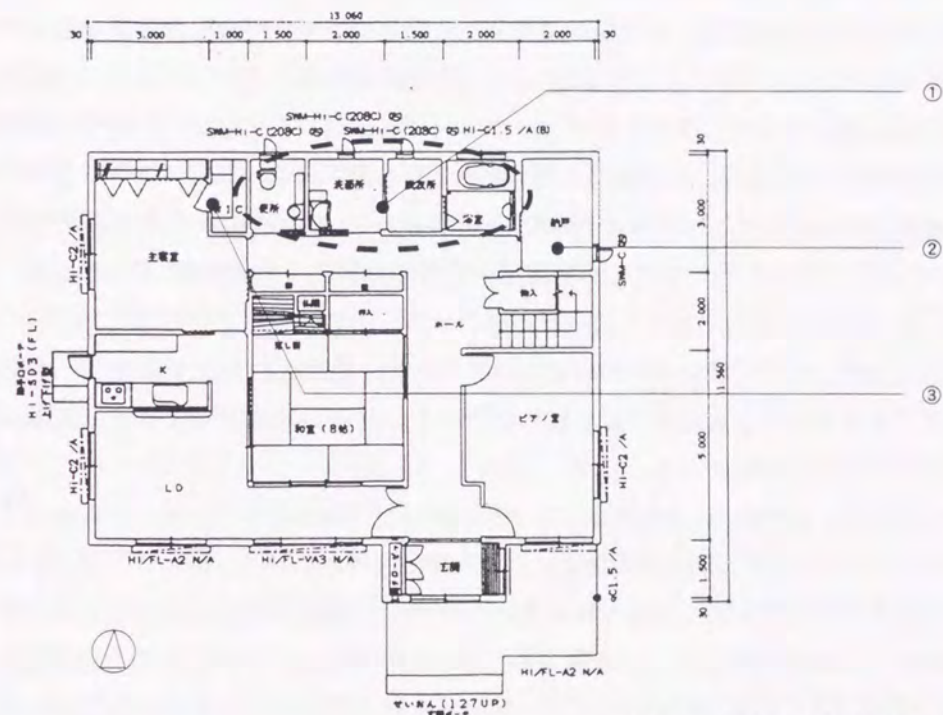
KI邸 1階平面図(1999.8.13) 1/200
